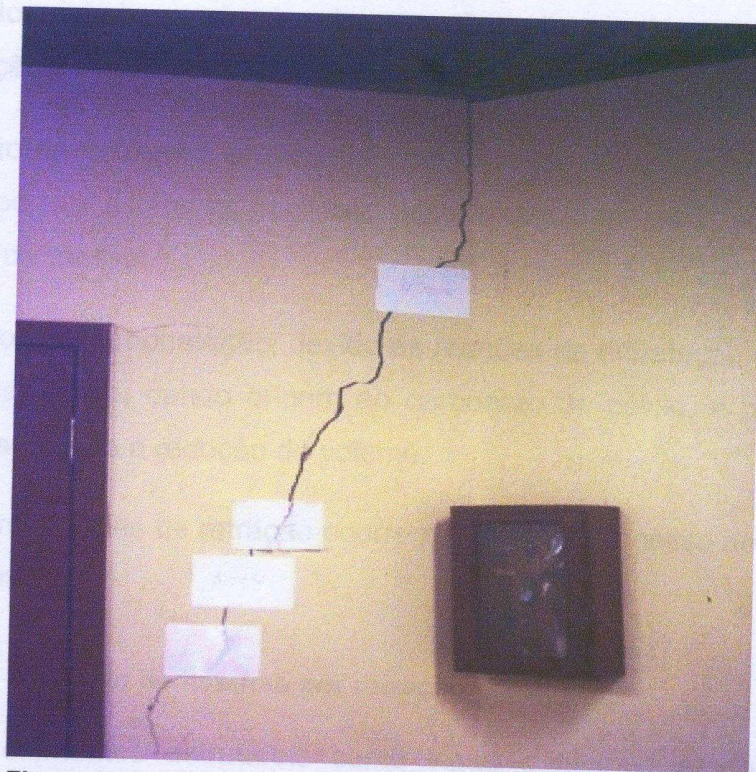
fissura causada por recalque de fundação de pilar de canto. (ROCHA, 2008).
